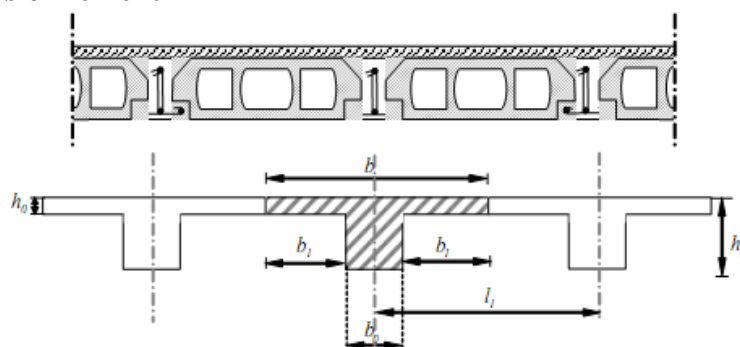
Coupe verticale sur plancher en corps creux.
